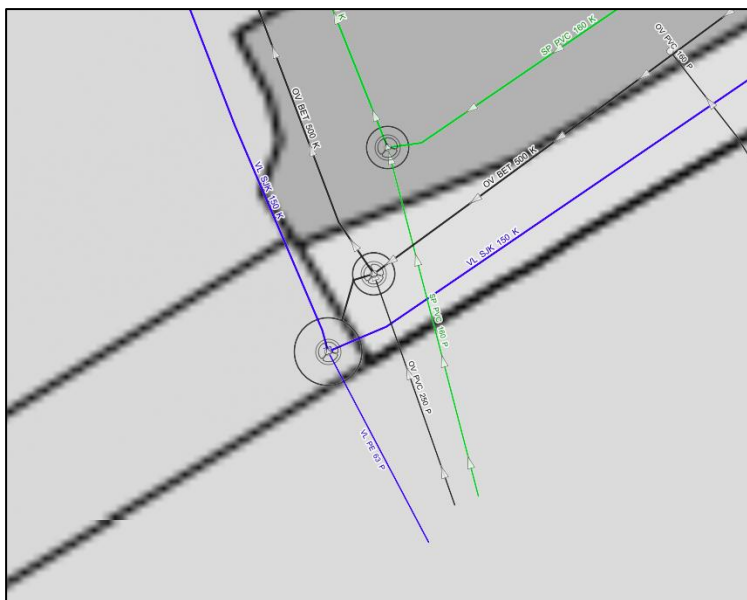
Ny ledningstrase like øst for planområdet, som planlagt i planforslag for Norheimmarka (planID 5096)
